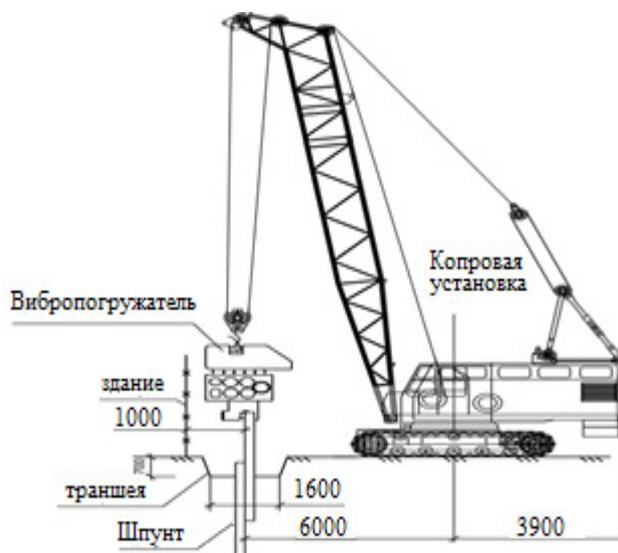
Схема вибропогружения свай с помощью копровой установки с навесным оборудованием
